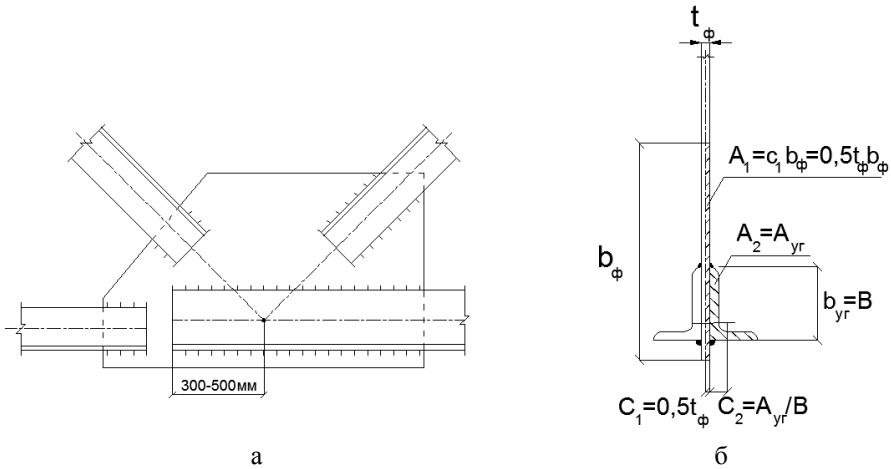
Узел изменения сечения нижнего пояса типовых стропильных ферм (а) и расчетная схема для определения геометрических параметров соединения пояса большего сечения со стенкой (б)
